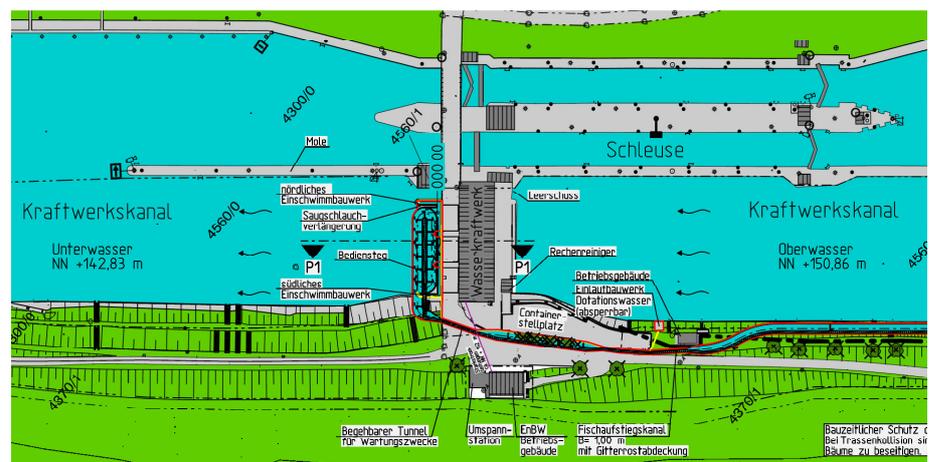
Planausschnitt Lageplan Variante 1 - Vorplanung (Stand Oktober 2011)
